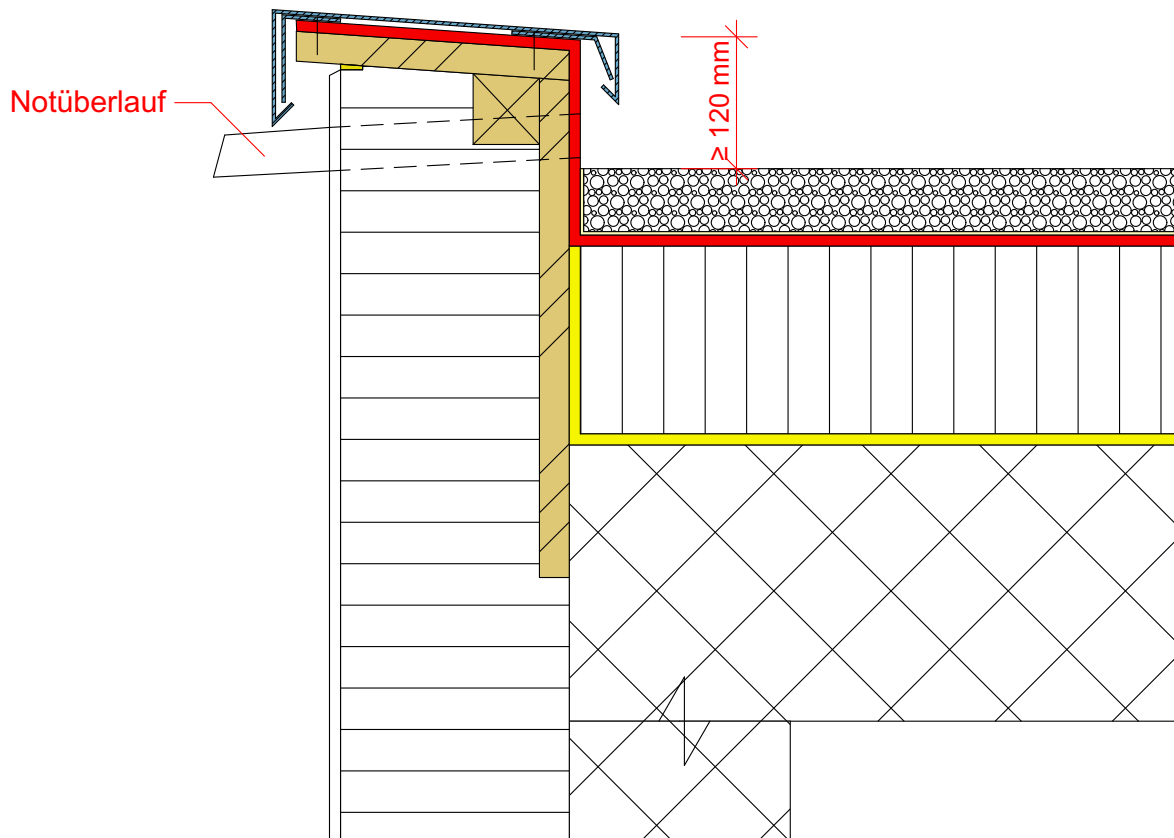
Nicht überlaufsichere Dachrandkonstruktionen
